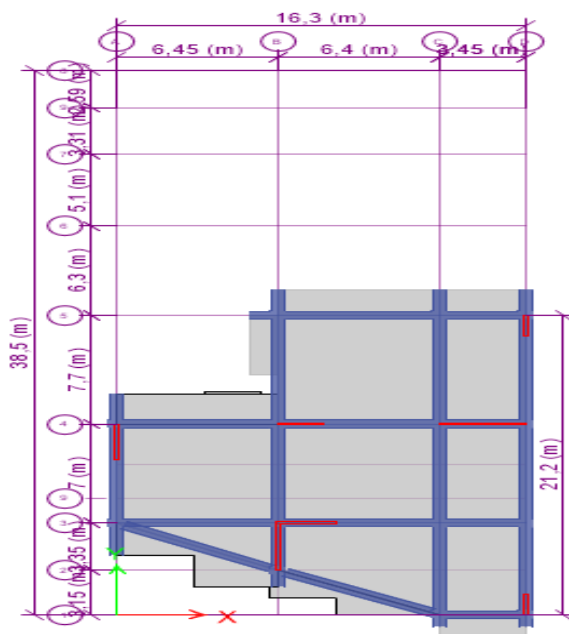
Vu en plan de la disposition des voiles de contreventement
